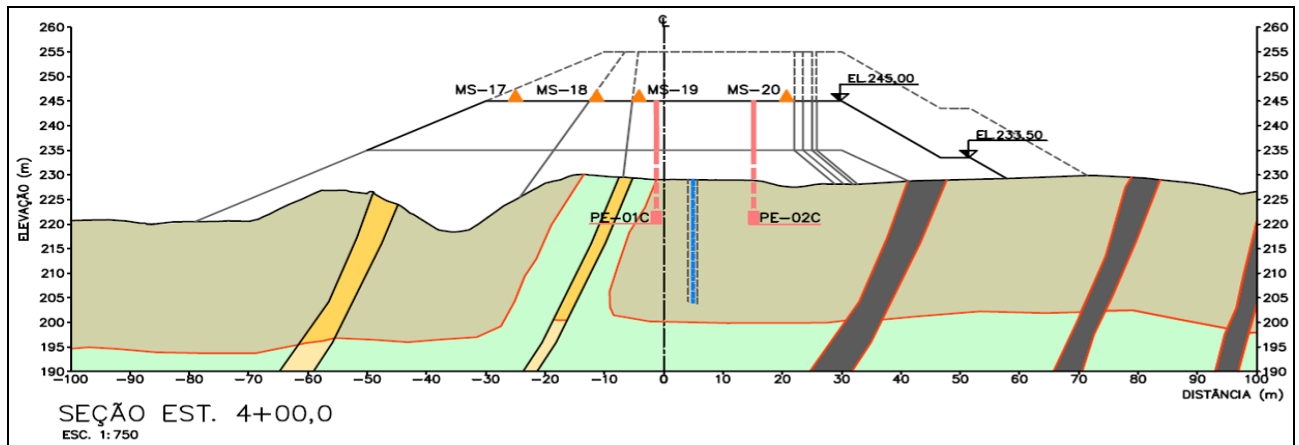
Seção 4+0,00 (9002SA-X-70527)
